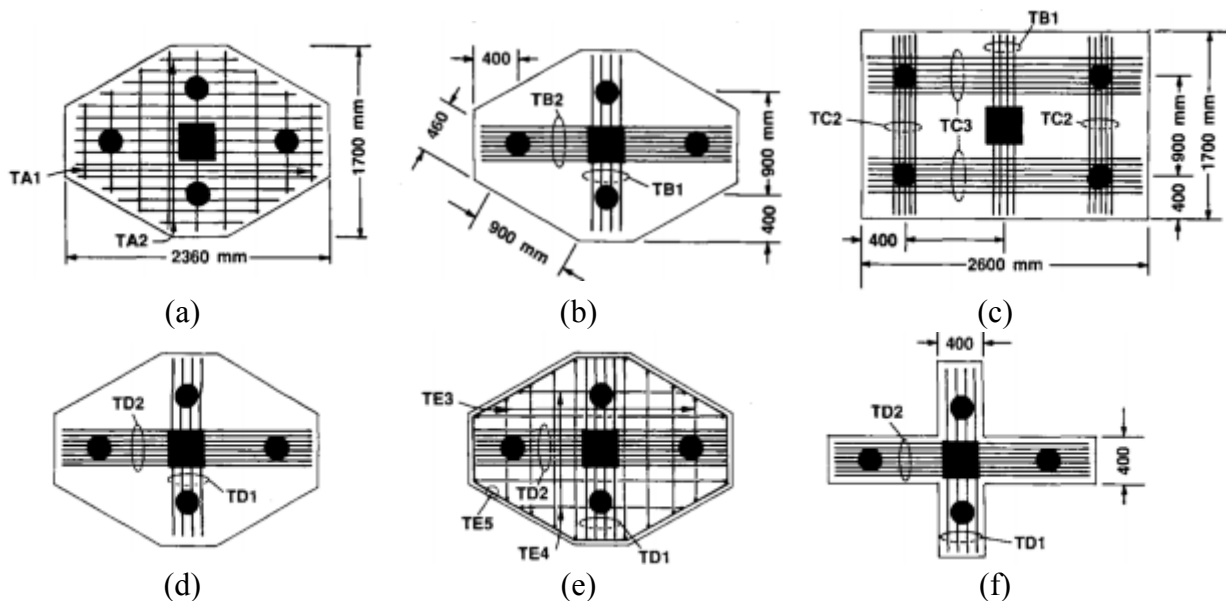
Planta encepados ensayados por Adebar et al. (1990) [5]
